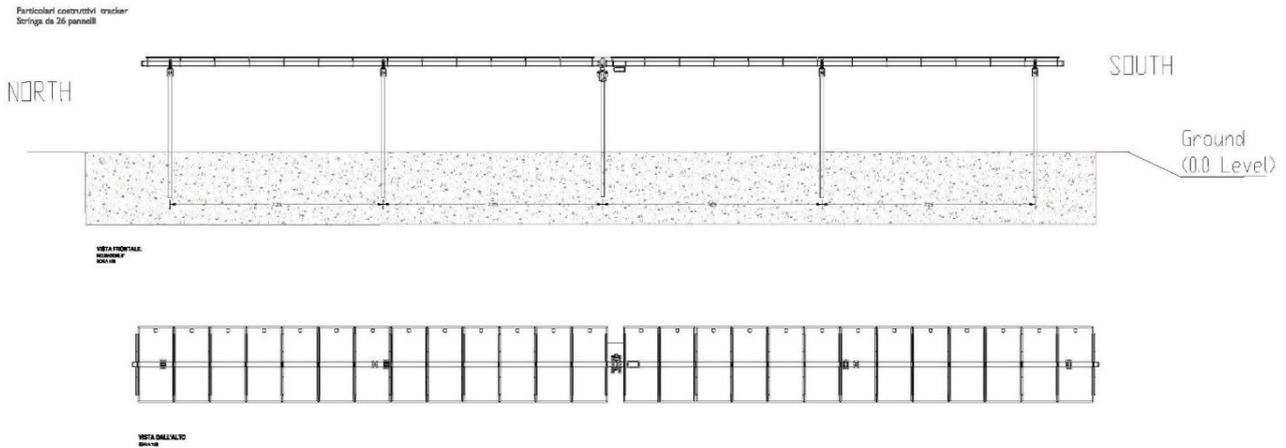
Vista laterale e vista dall’alto della singola stringa da 26 moduli
